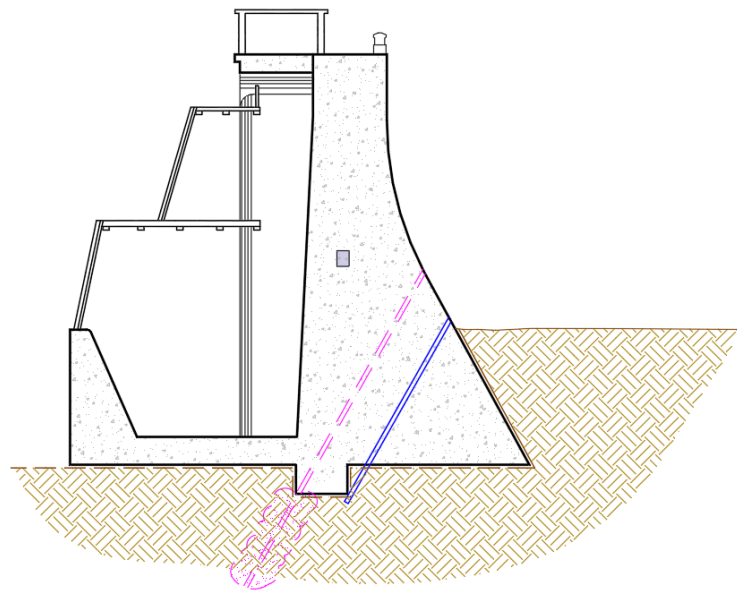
Interventi di progetto – profilo su sezione di spalla (spalla sx)
